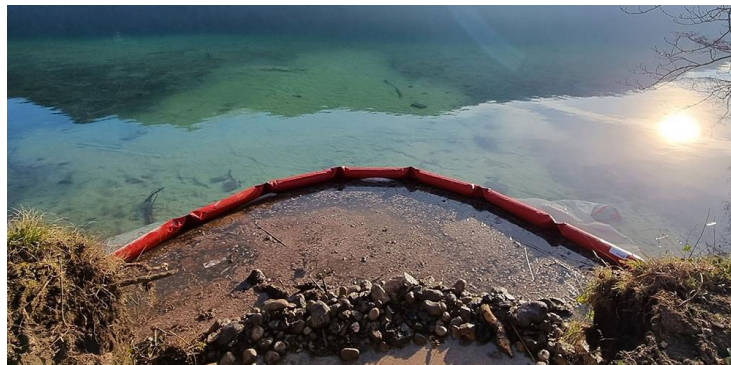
Exemple de barrage flottant avec jupe filtrante anti-MES
